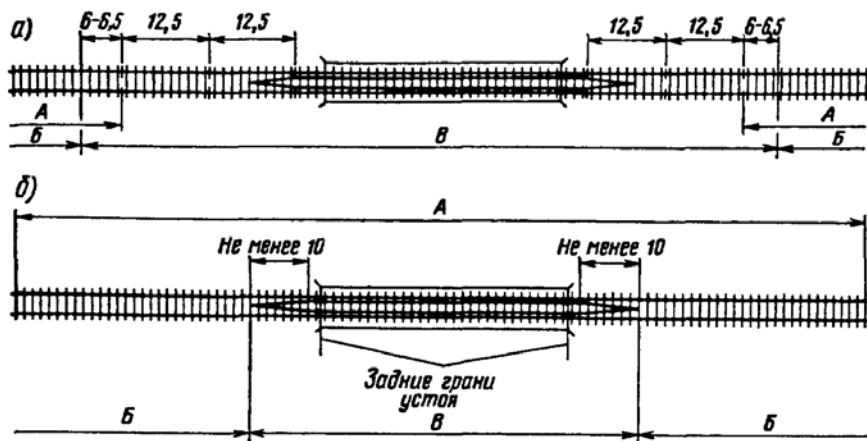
Схемы расположения железобетонных и деревянных шпал при примыкании рельсовых плетей к мостам (а) и перекрытии мостов рельсовыми плетями (б): А — рельсовые плети; Б — железобетонные шпалы; В — деревянные шпалы
